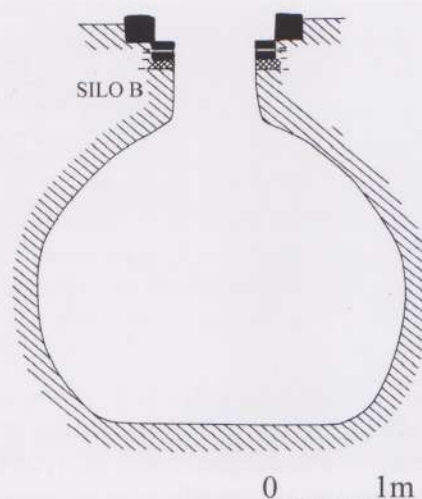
Gimont. Abbaye de Planselve. Porterie. Profil du silo B (relevé J. Lajoux, P. Labedan, J.-M.Lassure)
